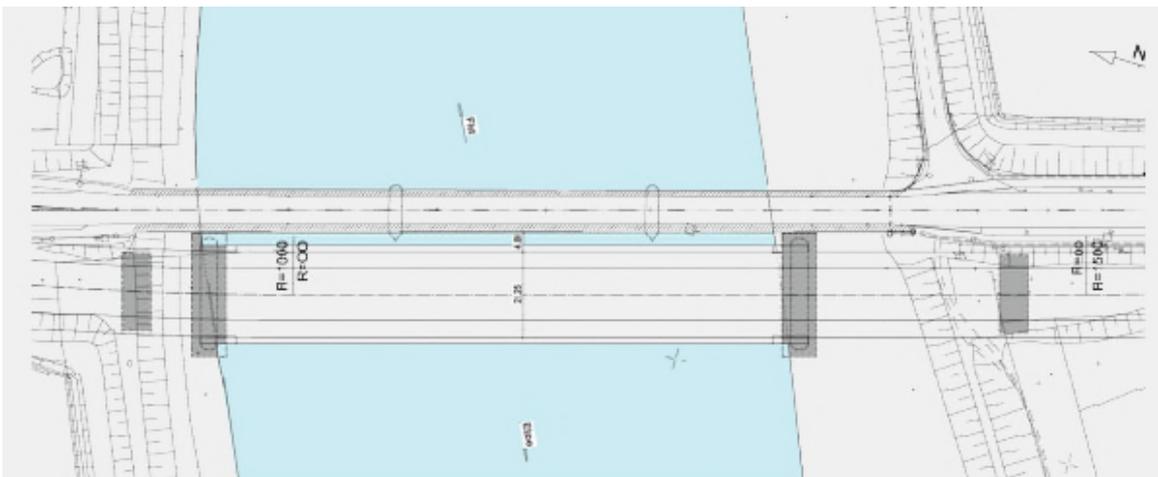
Lageplan der Überbauvariante 4.3 Bogenbrücke in Verbindung mit Trassenvariante 1 gemäß /3/
